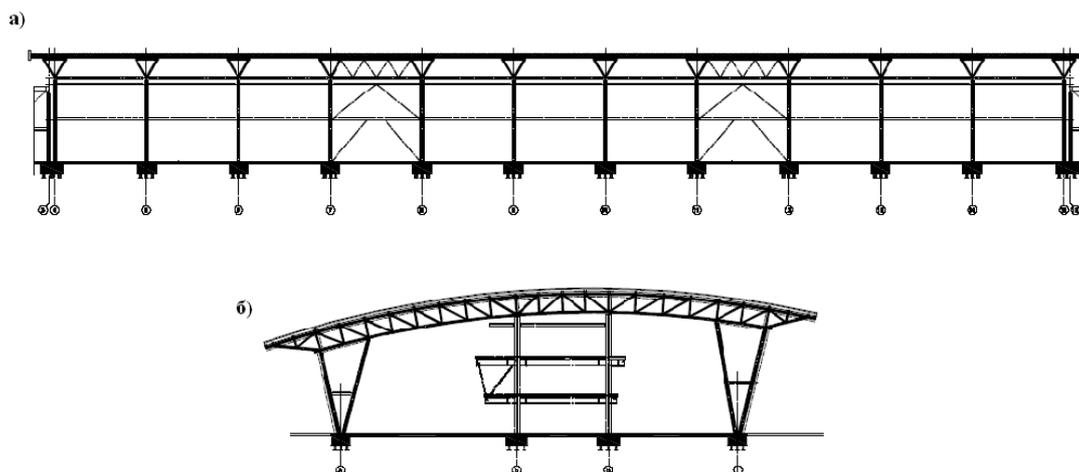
Конструктивная схема здания: а – продольный разрез; б – поперечный разрез
